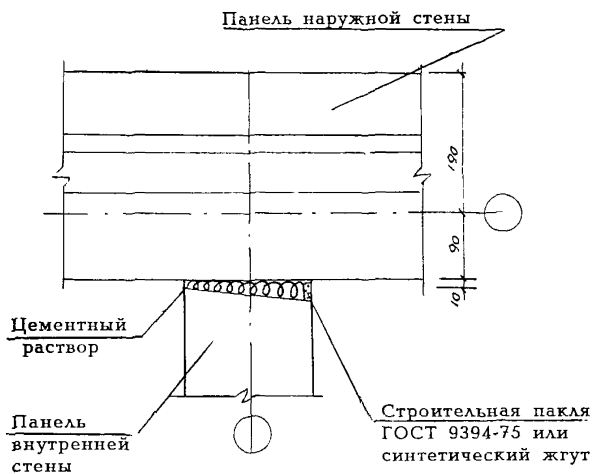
Закрытый вертикальный стык между внутренней и наружной стенами
